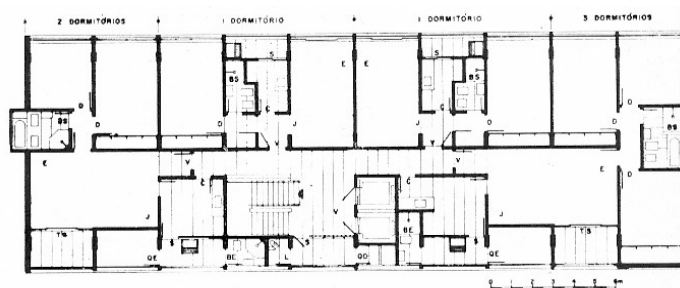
Planta do andar tipo: Edifício Brasil Portugal.
